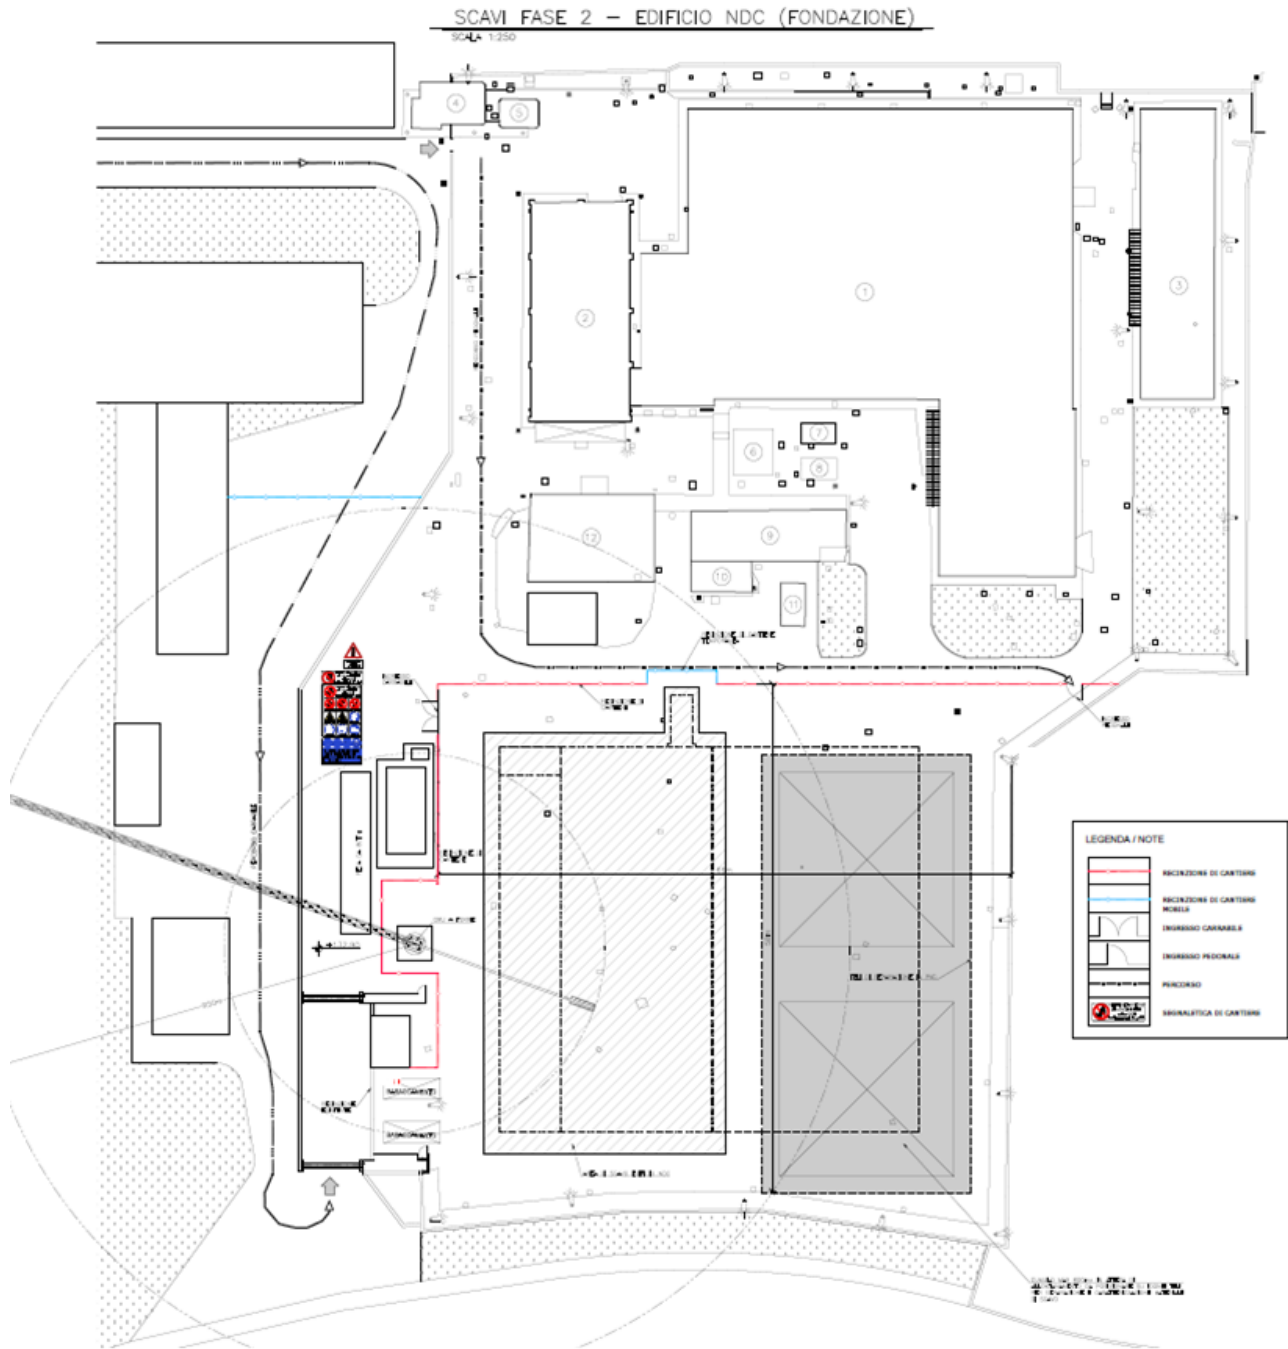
Realizzazione fondazione dell'edificio NDC - Scavi FASE 2
